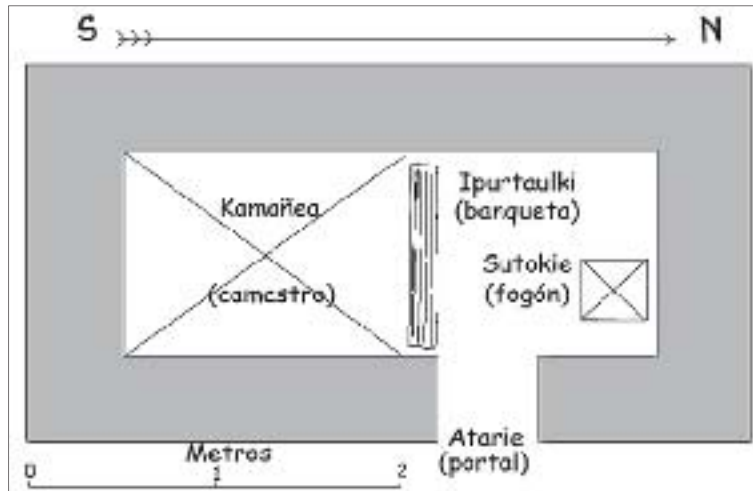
Croquis en planta de la Txabola de Saroxar (Atáun)
